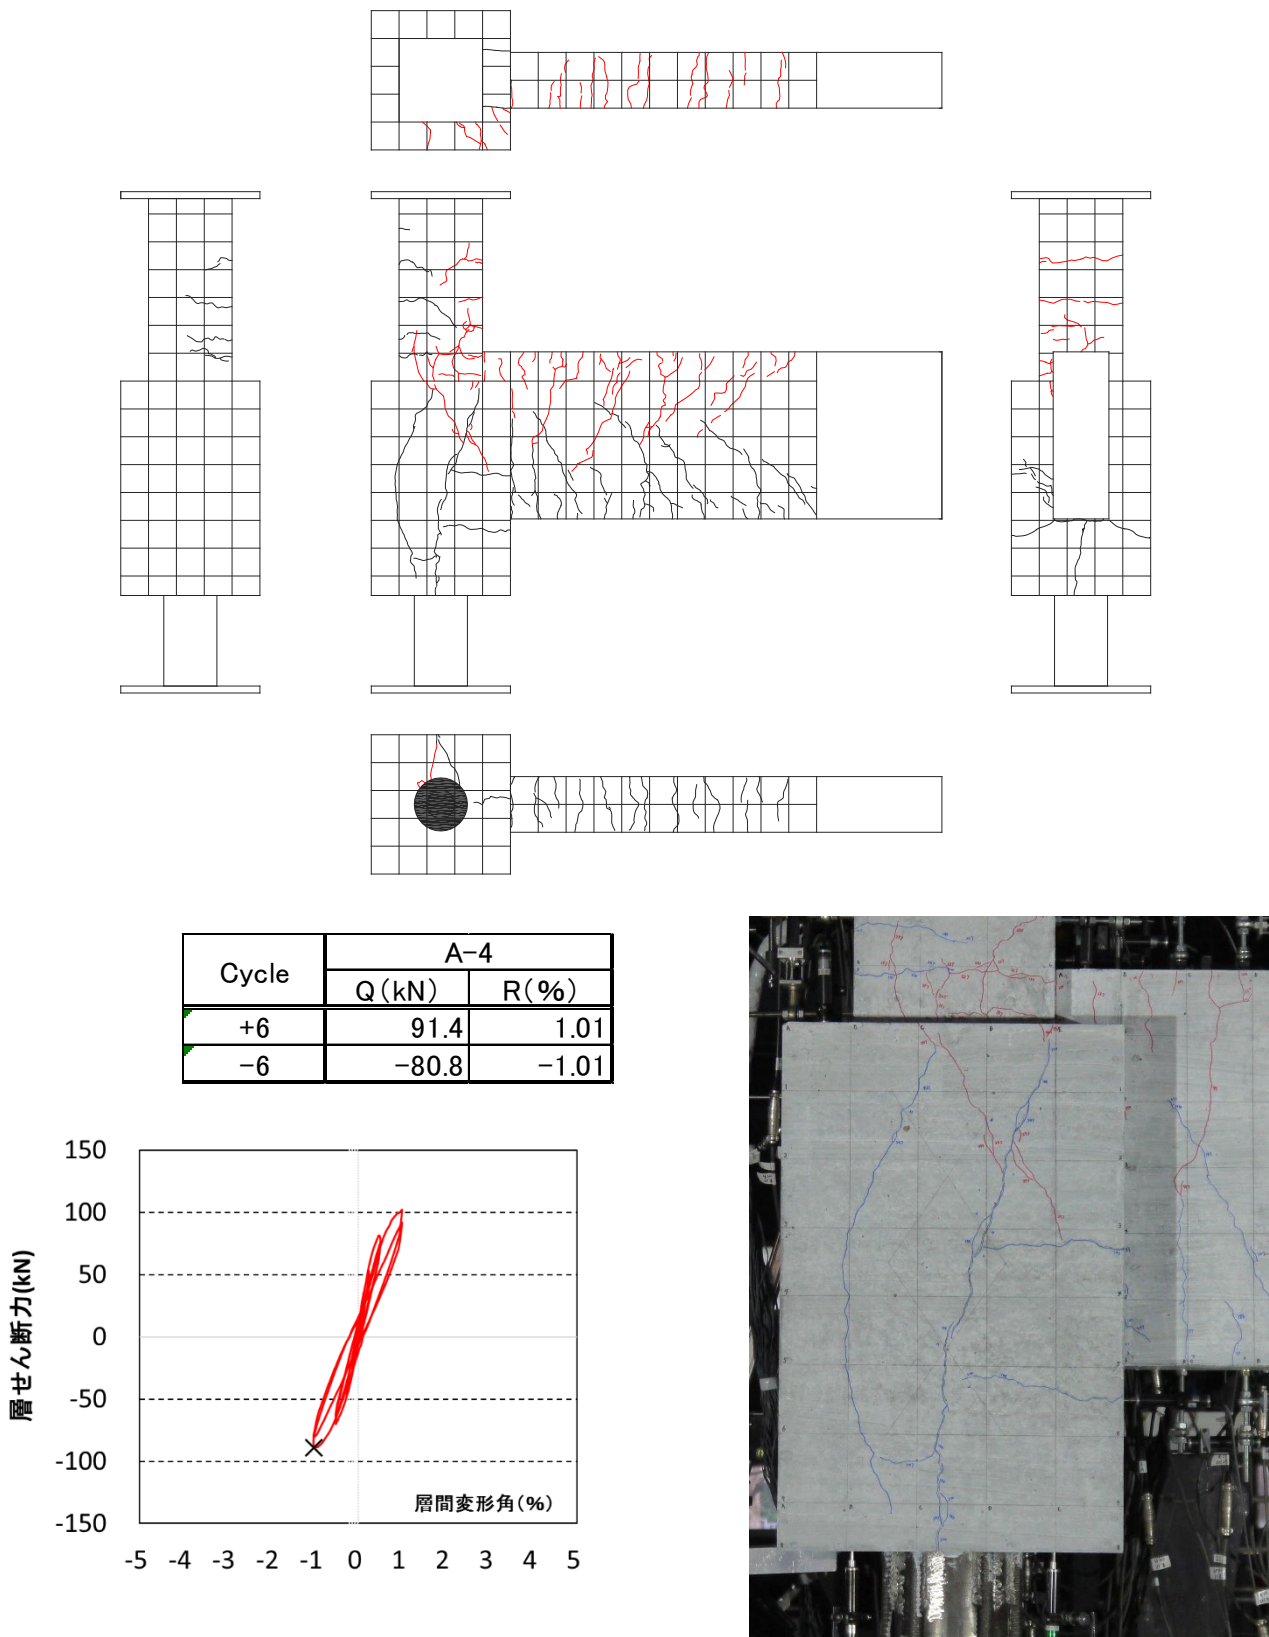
試験体 A-4 ひび割れ状況 (4Cycle)
